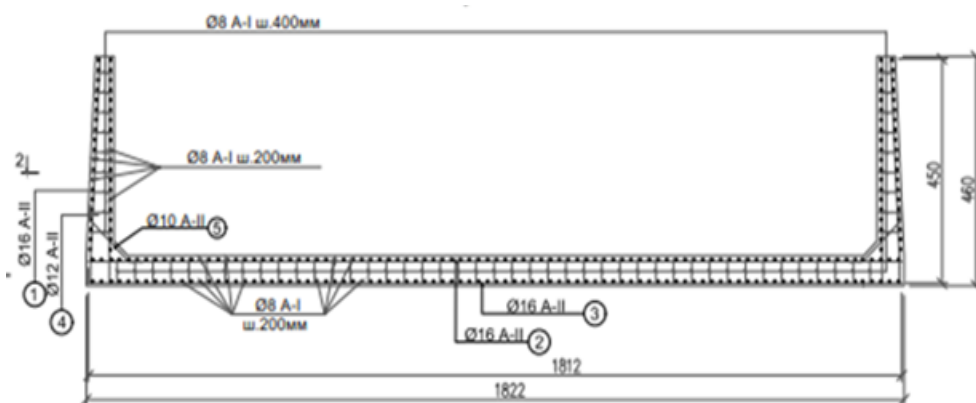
Арматурно-опалубочный чертежи проточной части гидротехнического сооружения доковой конструкции
